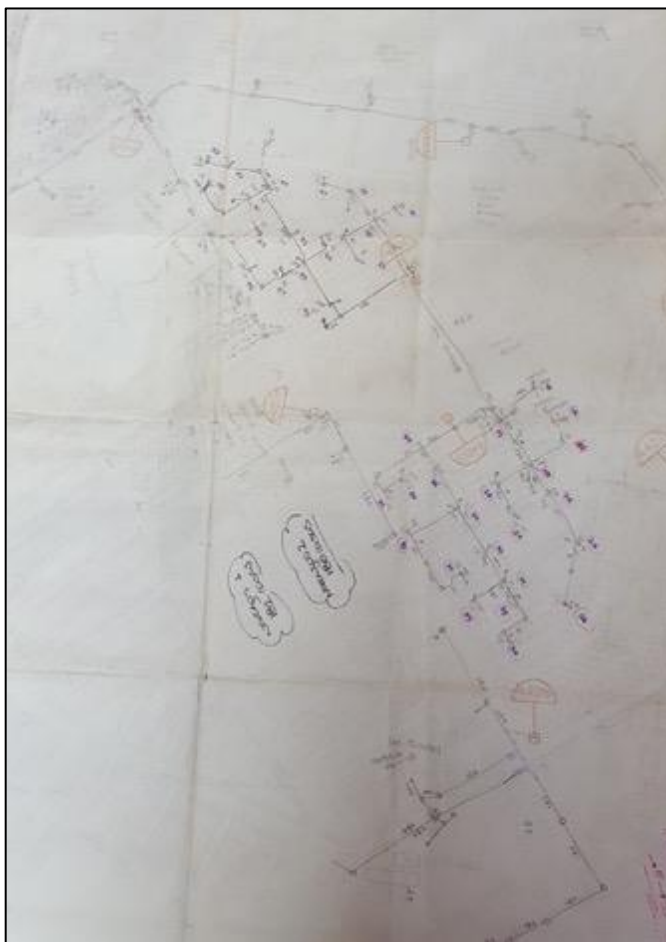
Planos de pre diseño sobre el levantamiento de canalización existente
